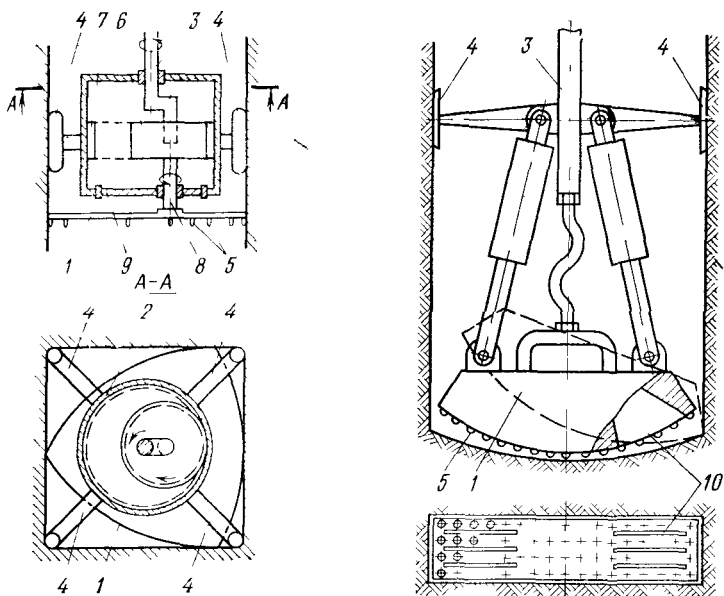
Конструкции долот для бурения скважин прямоугольного сечения: 1 — долото, 2 — невращающийся корпус, 3 — буровая колонна; 4 — упоры, 5 — зубья долота; 6, 7 — детали планетарного редуктора, 8 — вал, 9 — диск, 10 — щели для промывки
